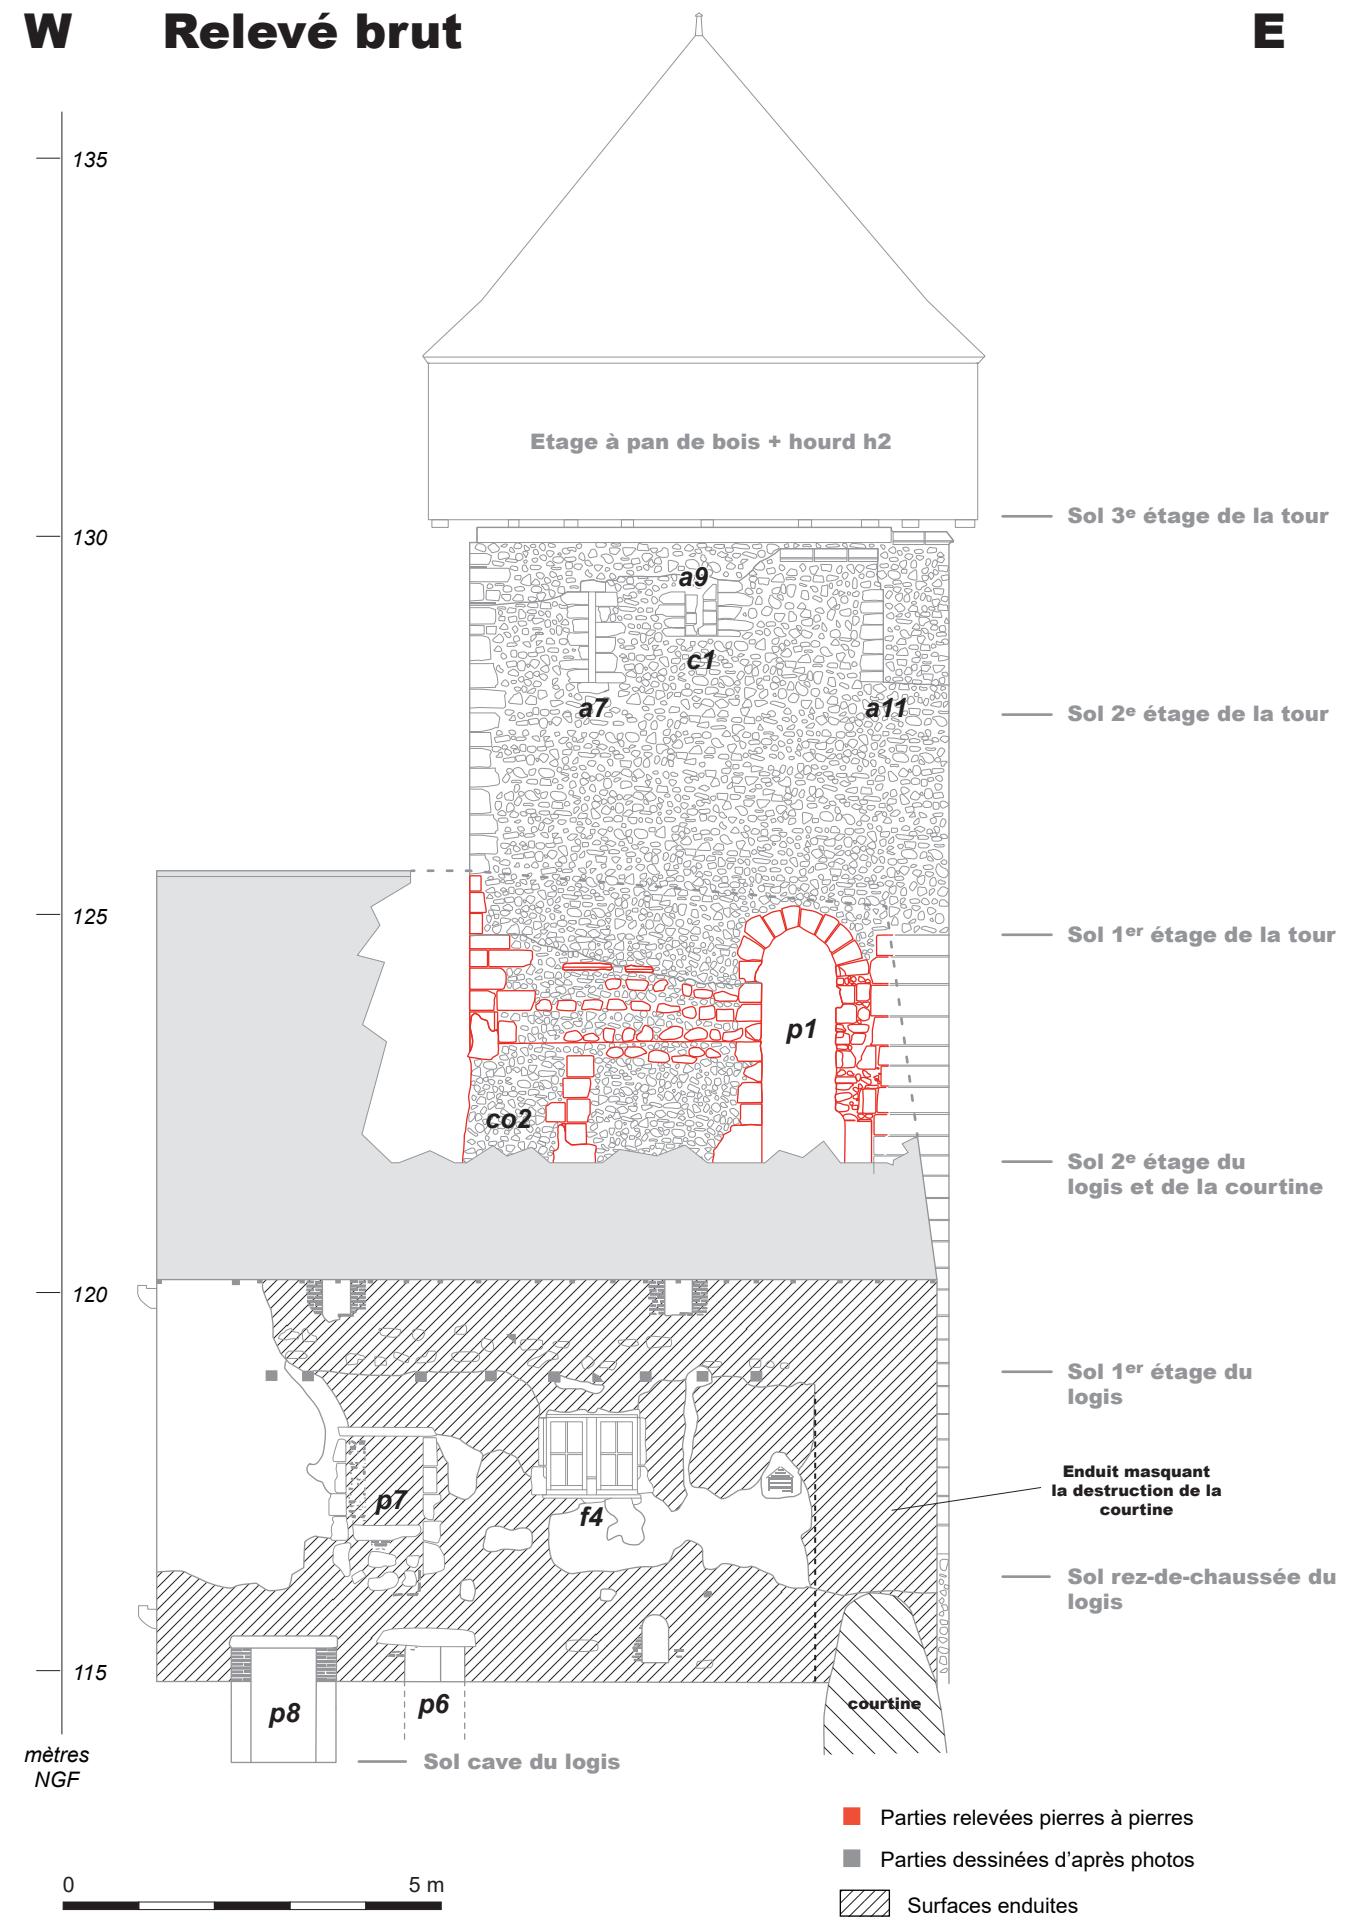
Elévation du mur sud de la tour et du bâtiment adossé
